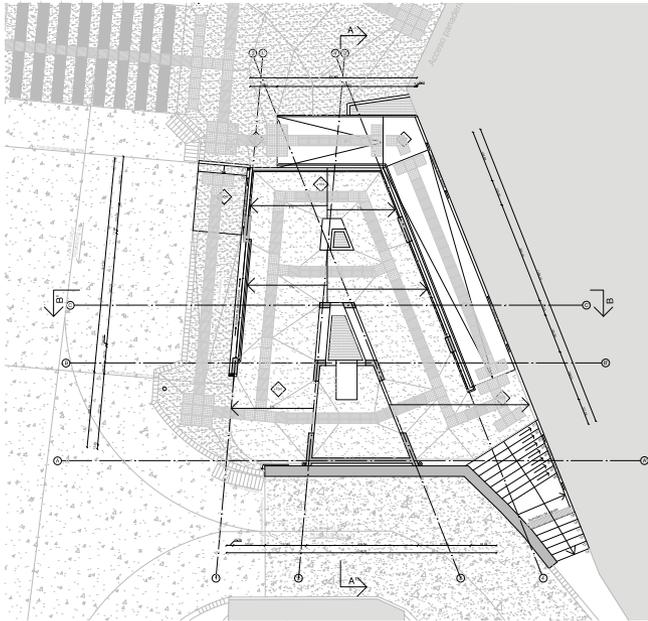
Planta de diseño de pavimentos, Intervención Plazuela Ecuador
